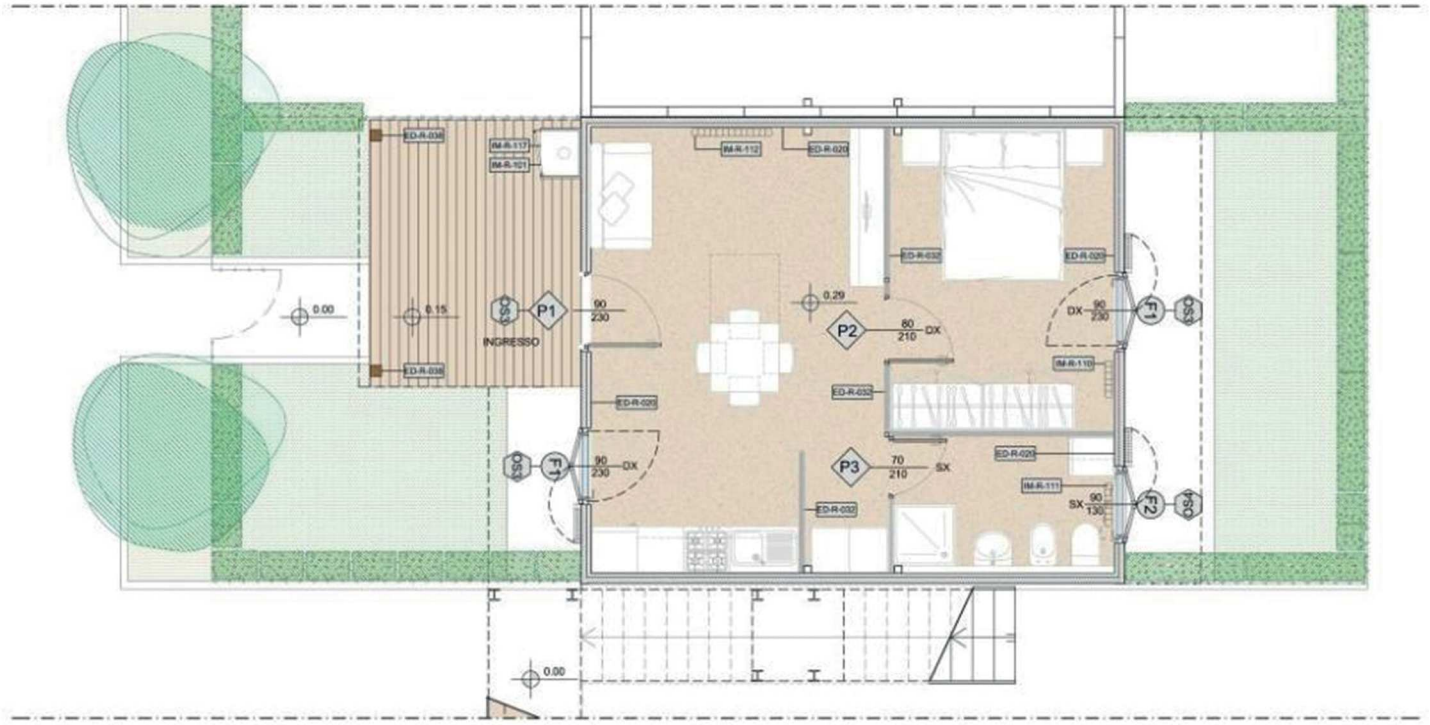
Pianta Piano Terra S.A.E. 40mq -
